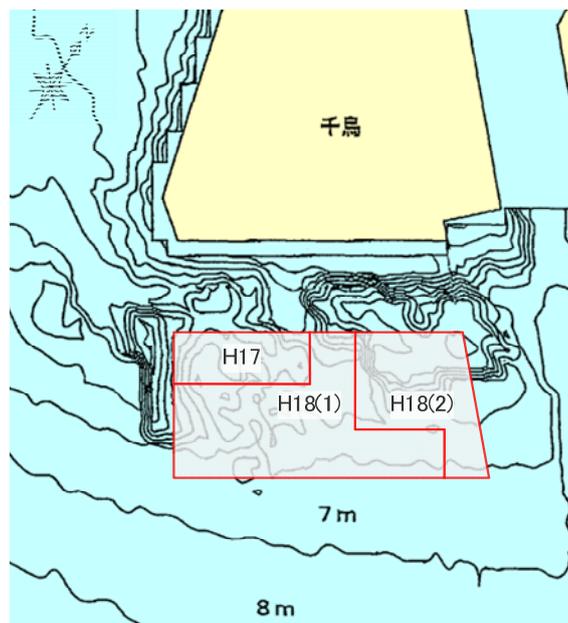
覆砂工事施工区域(H17 施工区域、H18 施工区域)
